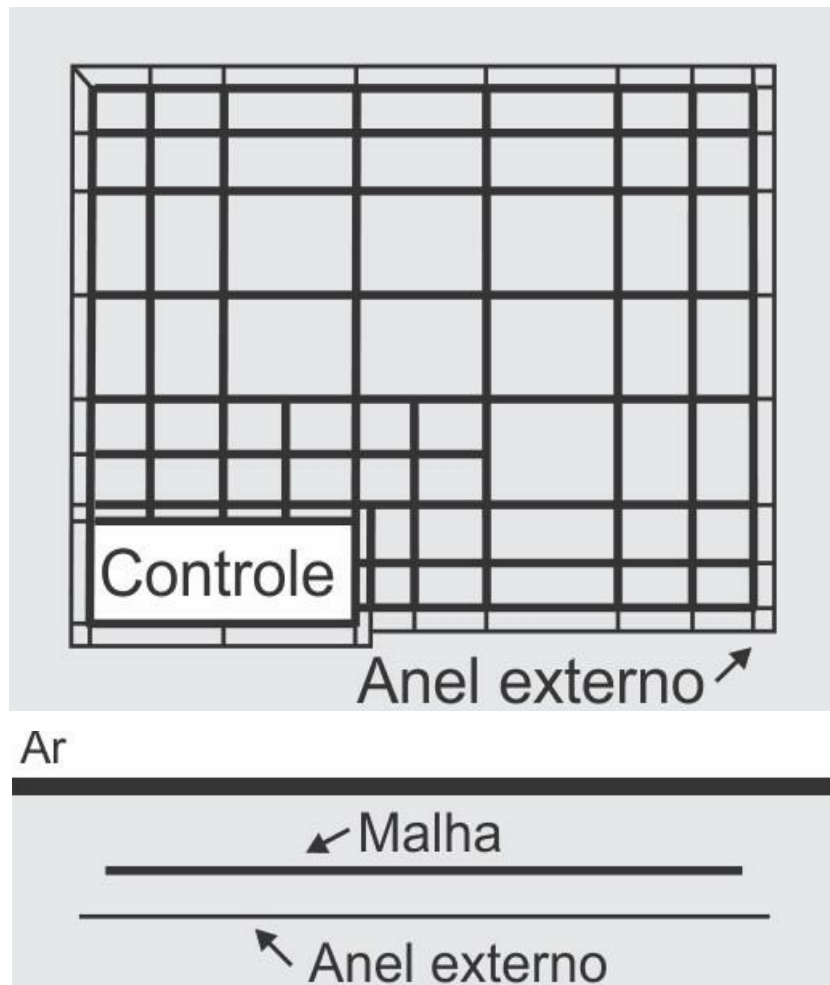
Sistema de aterramento de subestações. Vista de cima e vista em corte
